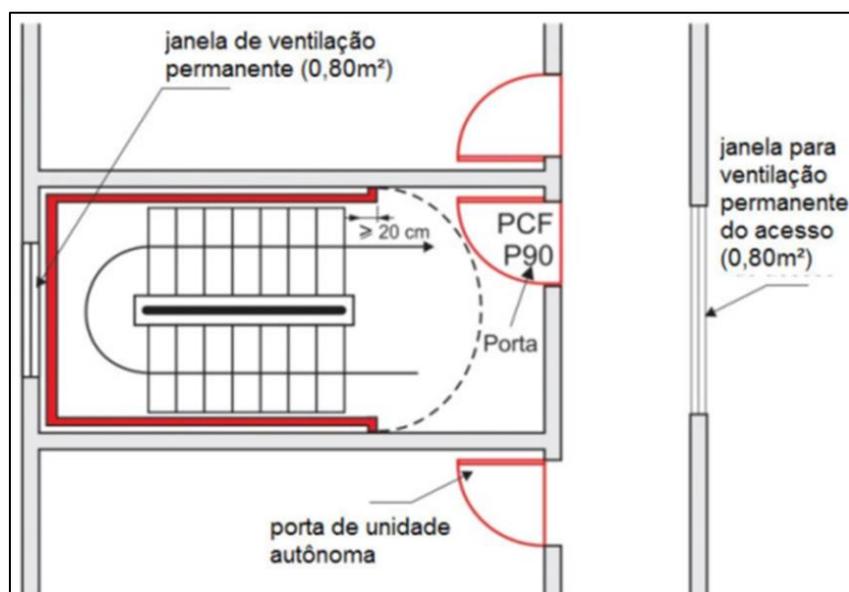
Planta da escada enclausurada protegida (EP) – ventilação e acesso
